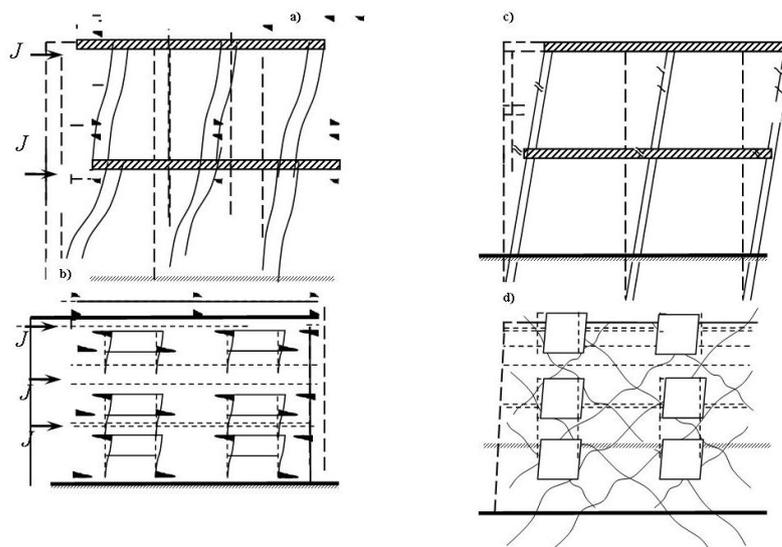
Каркасное здание и стены с проемами; ожидаемые схемы разрушений; с) д) фактические схемы разрушений
